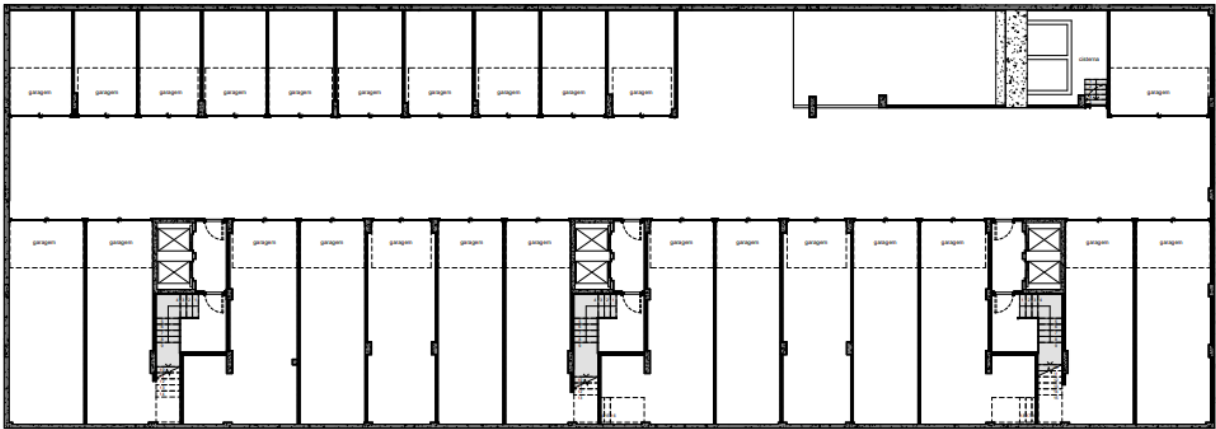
Recorte da planta de arquitetura do piso -2 do edifício Altavista 17 (1).
